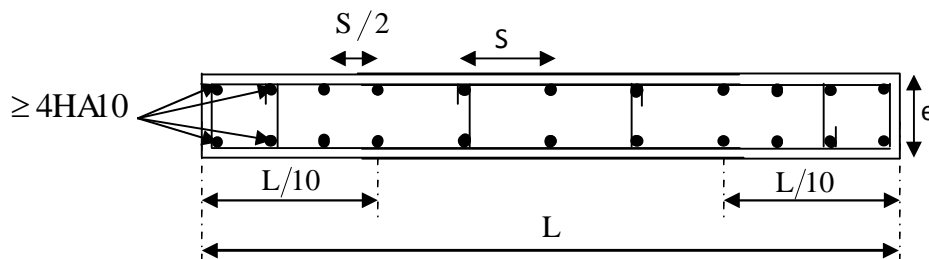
Disposition des armatures verticales dans les voiles.
